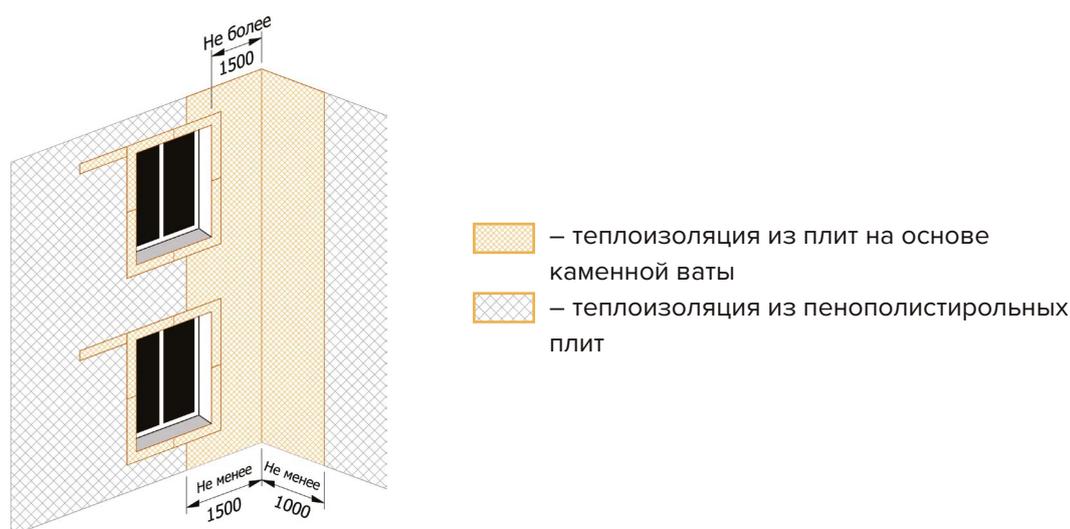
Размещение теплоизоляционных плит в зоне внутреннего угла при наличии проемов.
